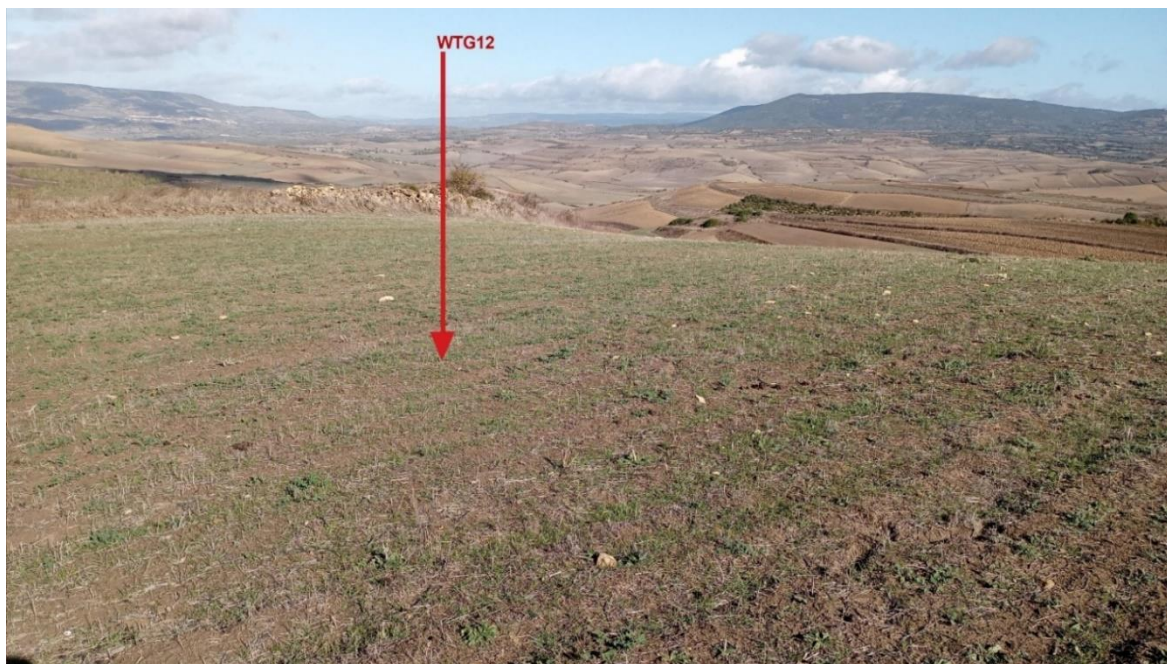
Area interessata dall'installazione della postazione WTG12
